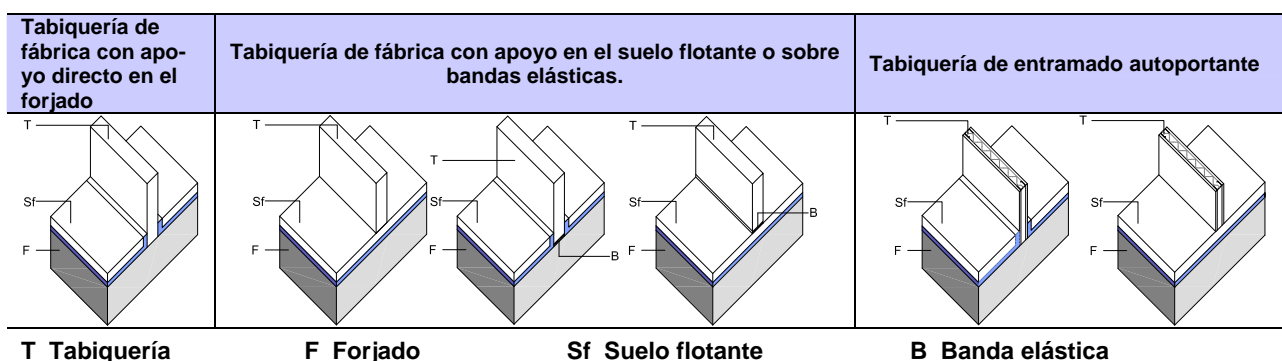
Tipos de tabiquería recogidos en el DB HR.
